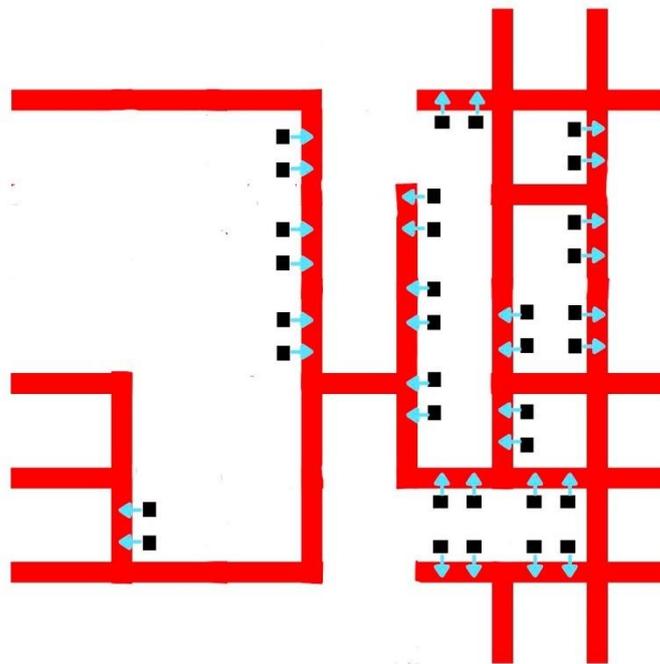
© plan fait par l'auteur -plan schématique montrant les entrées des maisons par rapport à la voirie
